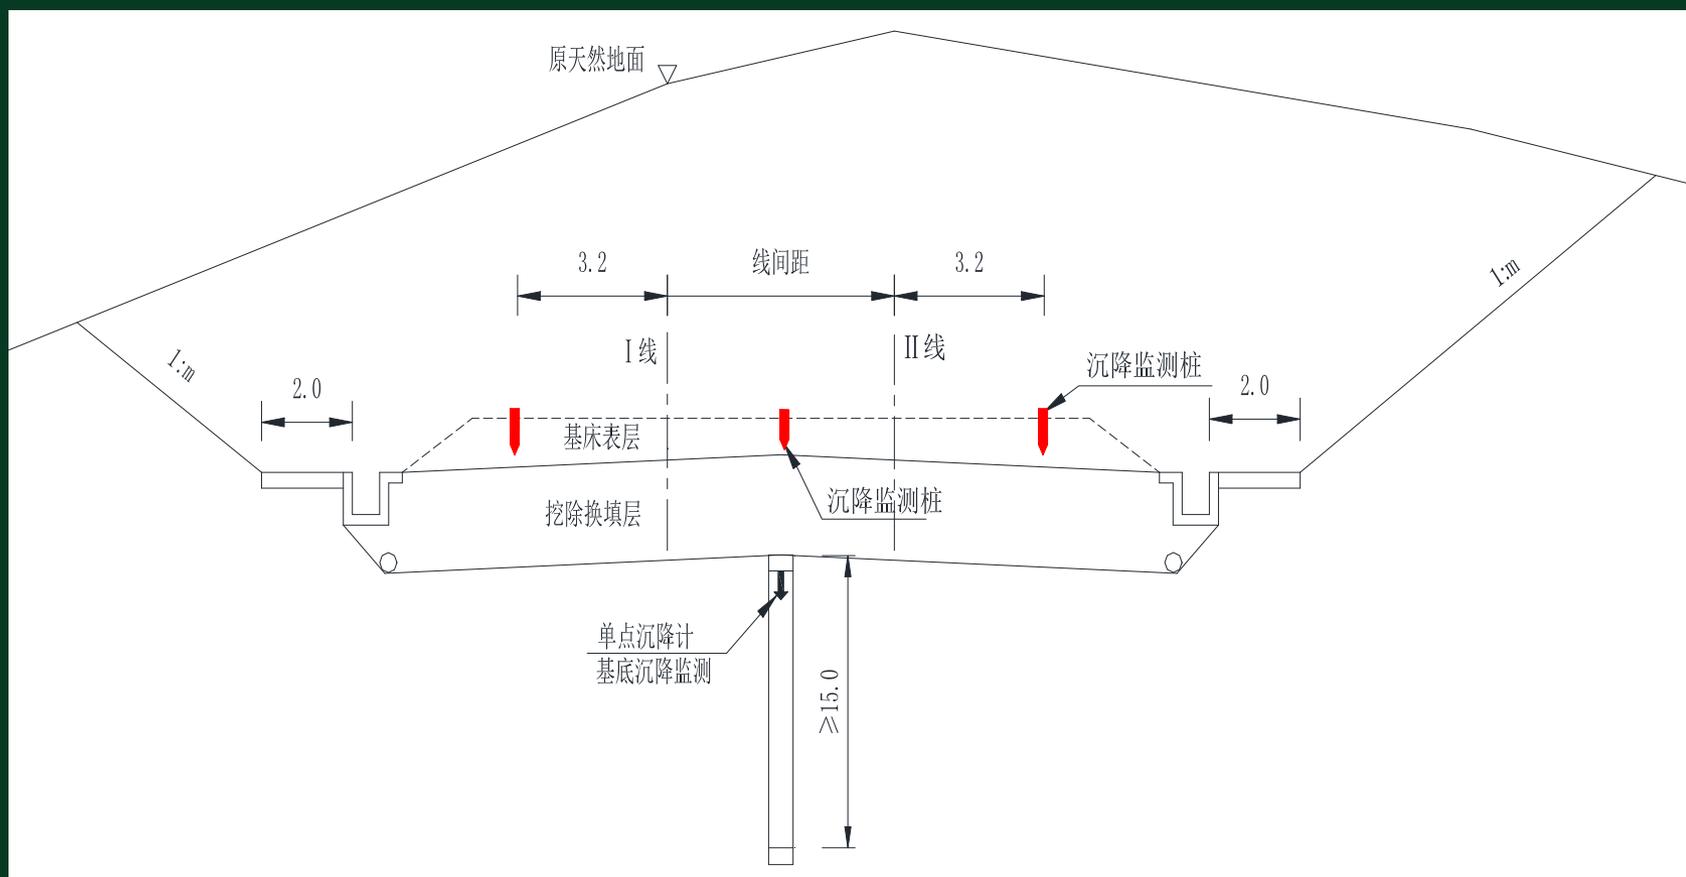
13红黏土、膨胀土路堑地段沉降监测剖面元件布置示意图（单位：m）
